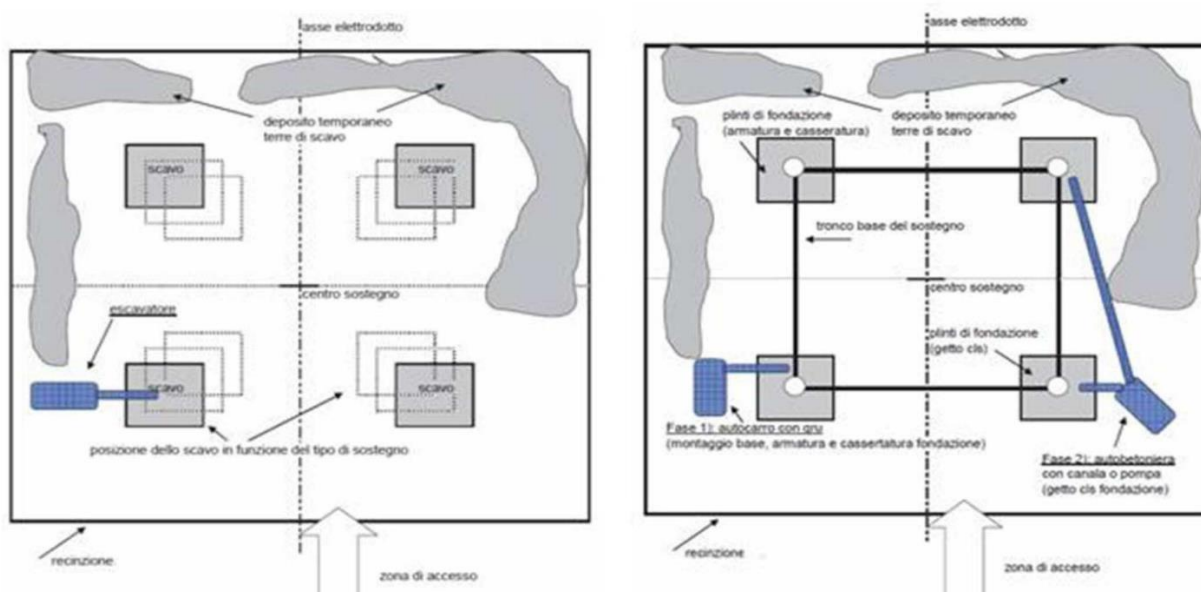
Planimetria tipologica di un microcantiere per una fondazione superficiale: a sinistra nella fase di scavo delle fondazioni; a destra nella fase di getto per la realizzazione dei plinti di fondazione.
